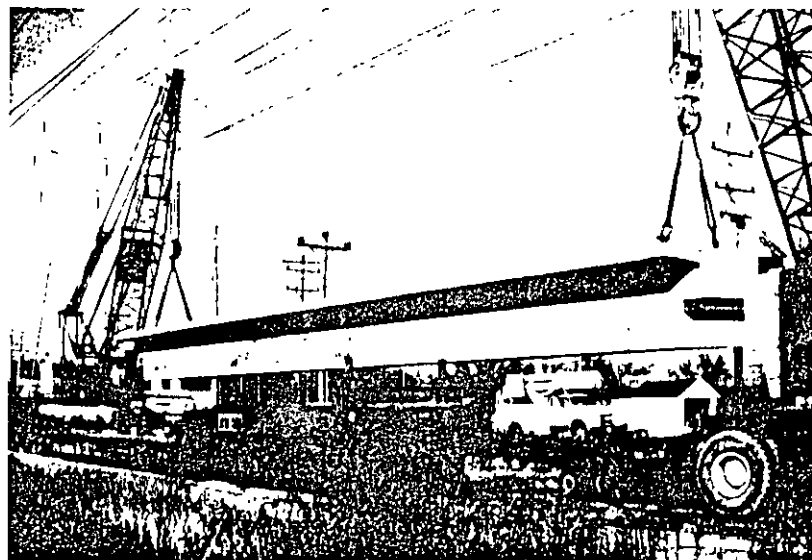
Grúas que izan una viga maestra, prefabricada, de 85 ton de peso, transportadora en un planchón especial de ferrocarril.
